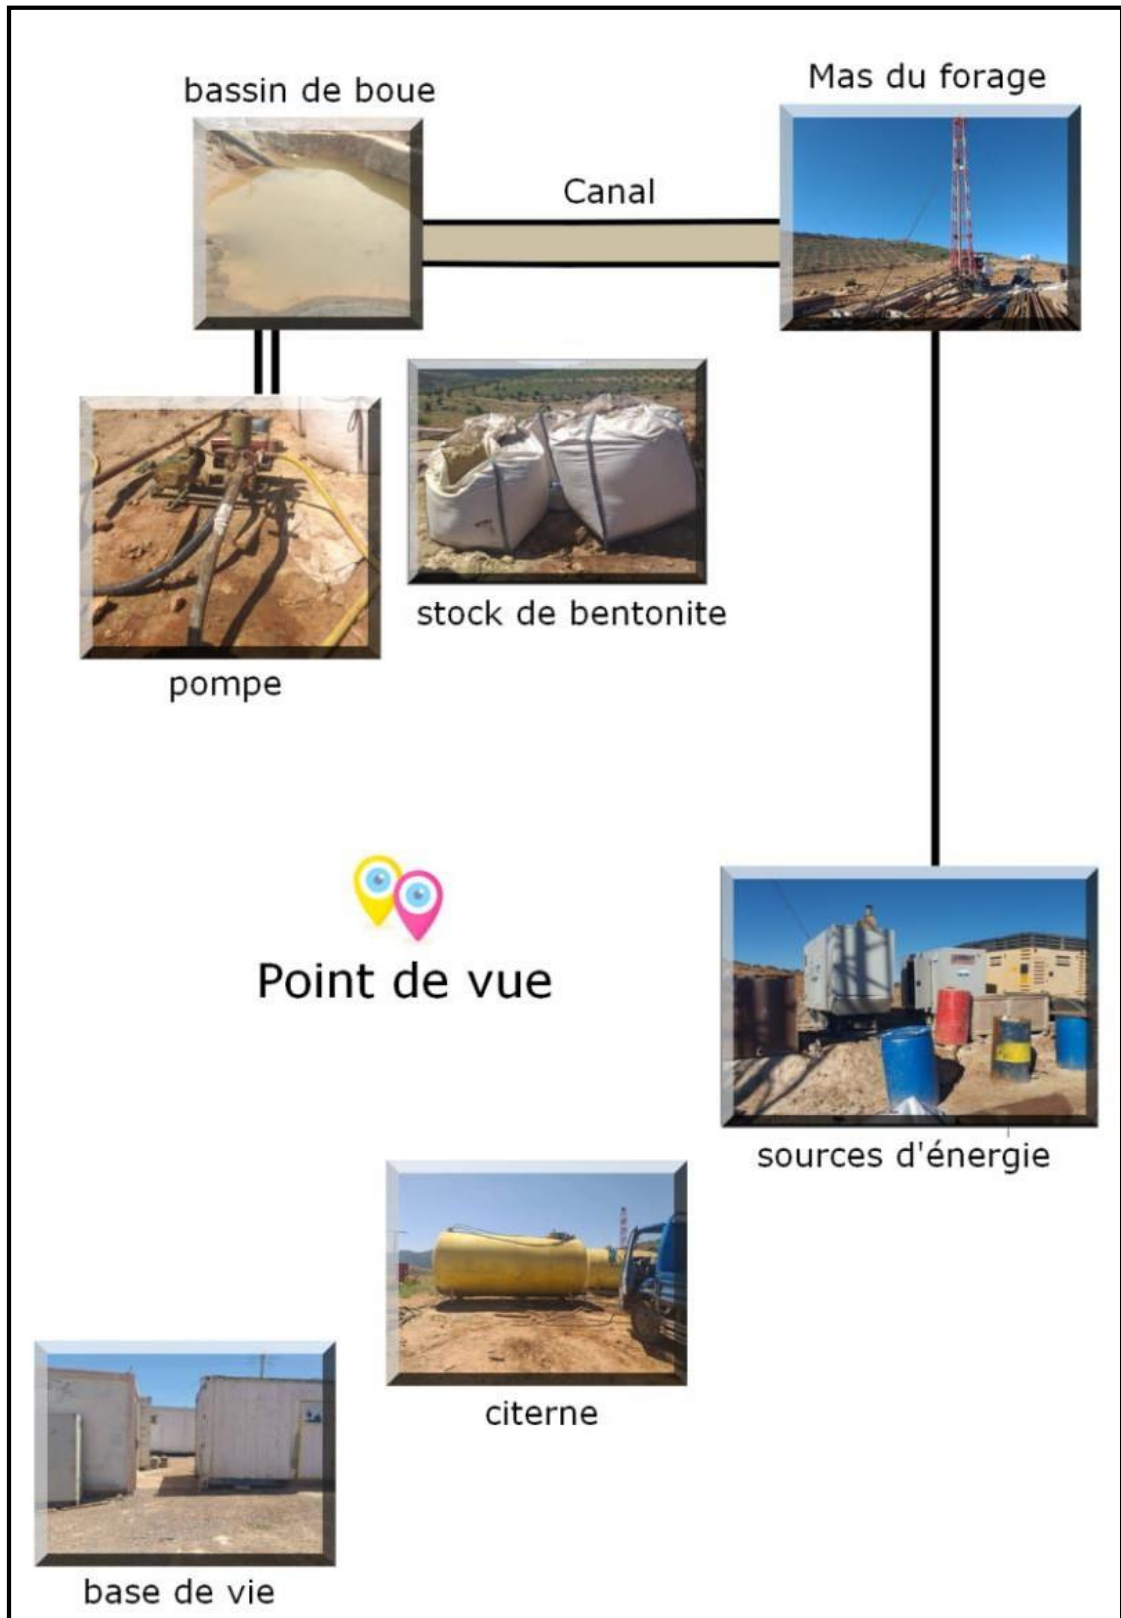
Plan du chantier vu le 11/ 05/ 2022
